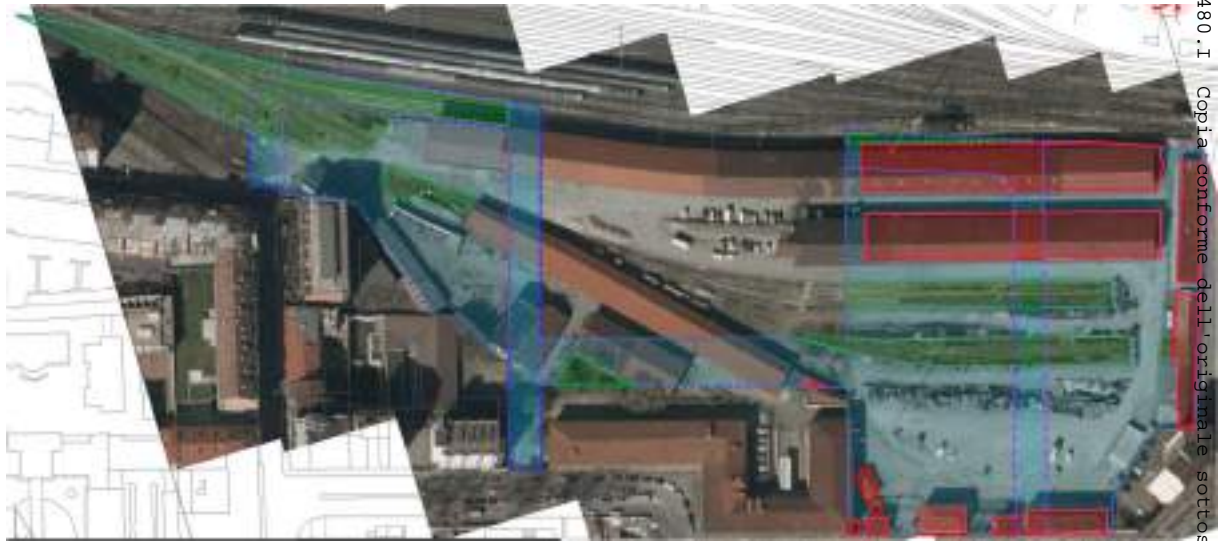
Planimetria dello stato di fatto delle superfici permeabili/impermeabili su foto aerea storica
